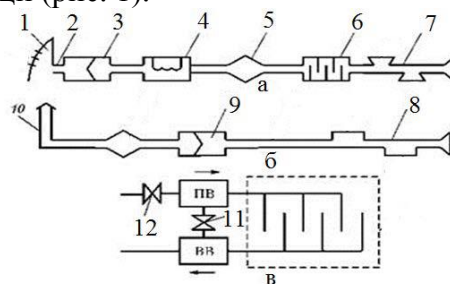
Схеми загальнообмінної механічної вентиляції: а – припливна вентиляція (ПВ); б – витяжна вентиляція (ВВ); в – припливно-витяжна вентиляція з рециркуляцією; 1 – повітрязабірний пристрій; 2 – повітропроводи; 3 – фільтр; 4 – калорифер; 5 – вентилятор; 6 – зволожувач-осушувач; 7 – повітророзподільник; 8 – повітроприймачі; 9 – апарат очищення повітря; 10 – розсіювач; 11,12 – регулювальні клапани.
